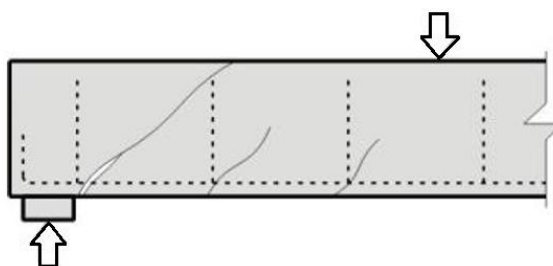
Ruptura na ausência de armaduras transversais eficazes (Fusco, 2008).
